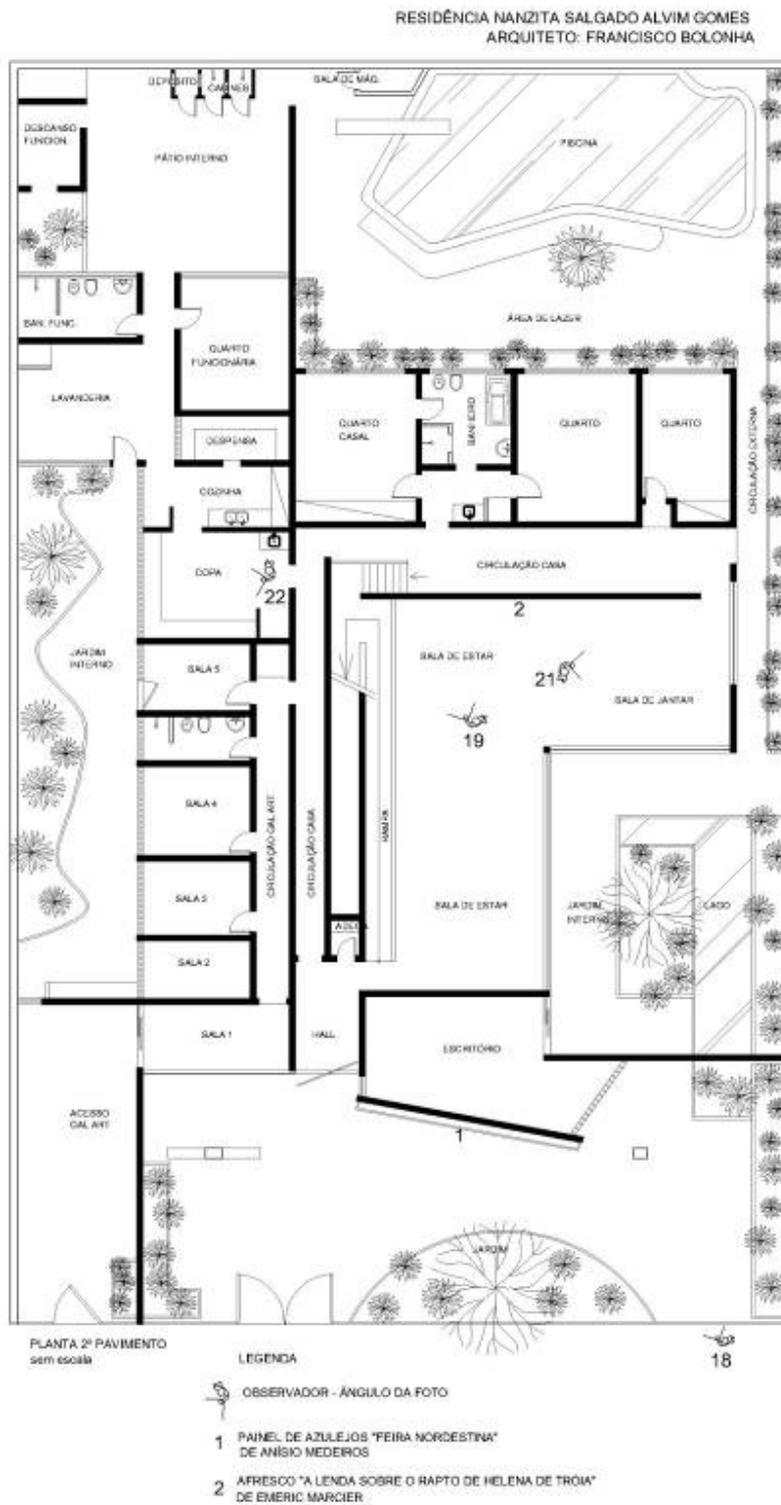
PLANTA 1º pavimento da Residência de Nanzita, arquiteto Francisco Bolonha. TELLES, Cairu (2007)
